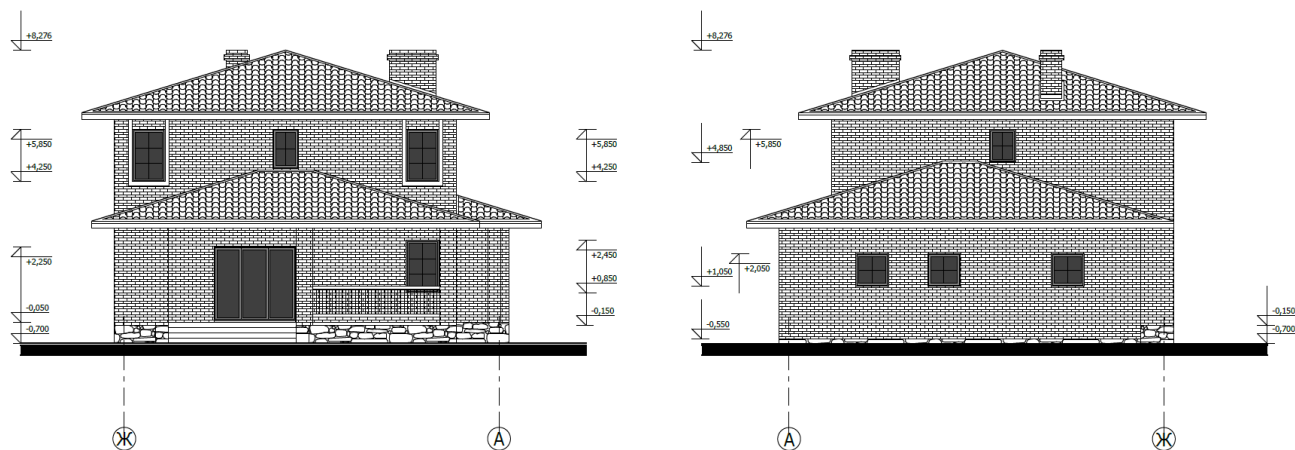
Фасади будинку Ж-А та А-Ж
